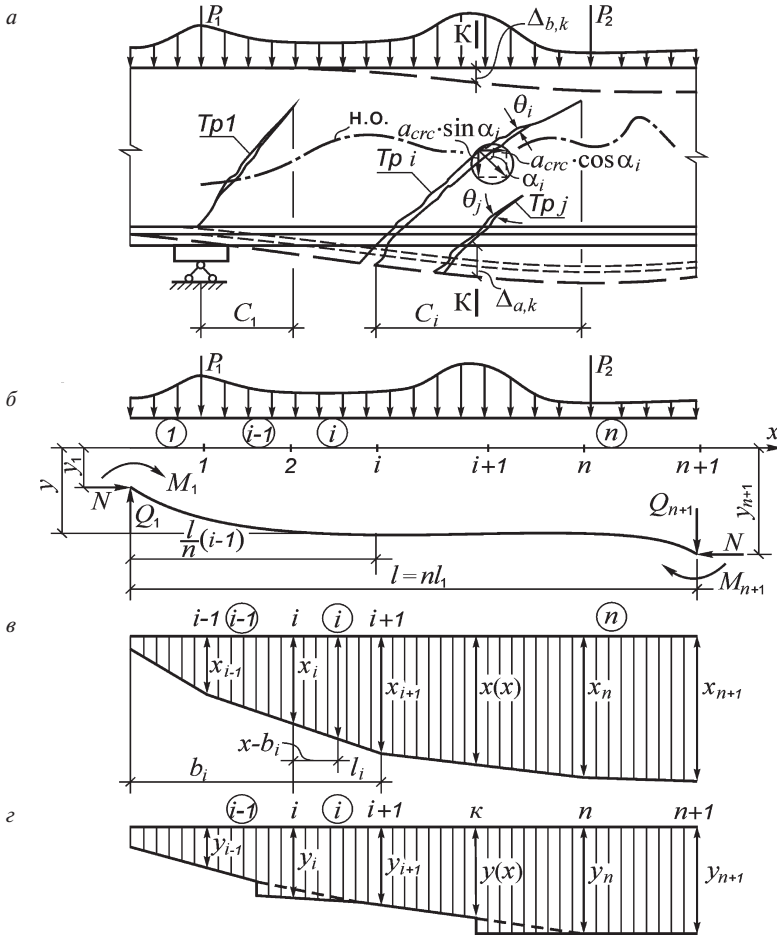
К расчету железобетонного элемента по деформациям на участках с наклонными трещинами: а – схема трещин и перемещения в сечении  $k$ ; б – расчетная схема стержня; в – эпюра кривизны; з – эпюра прогибов
